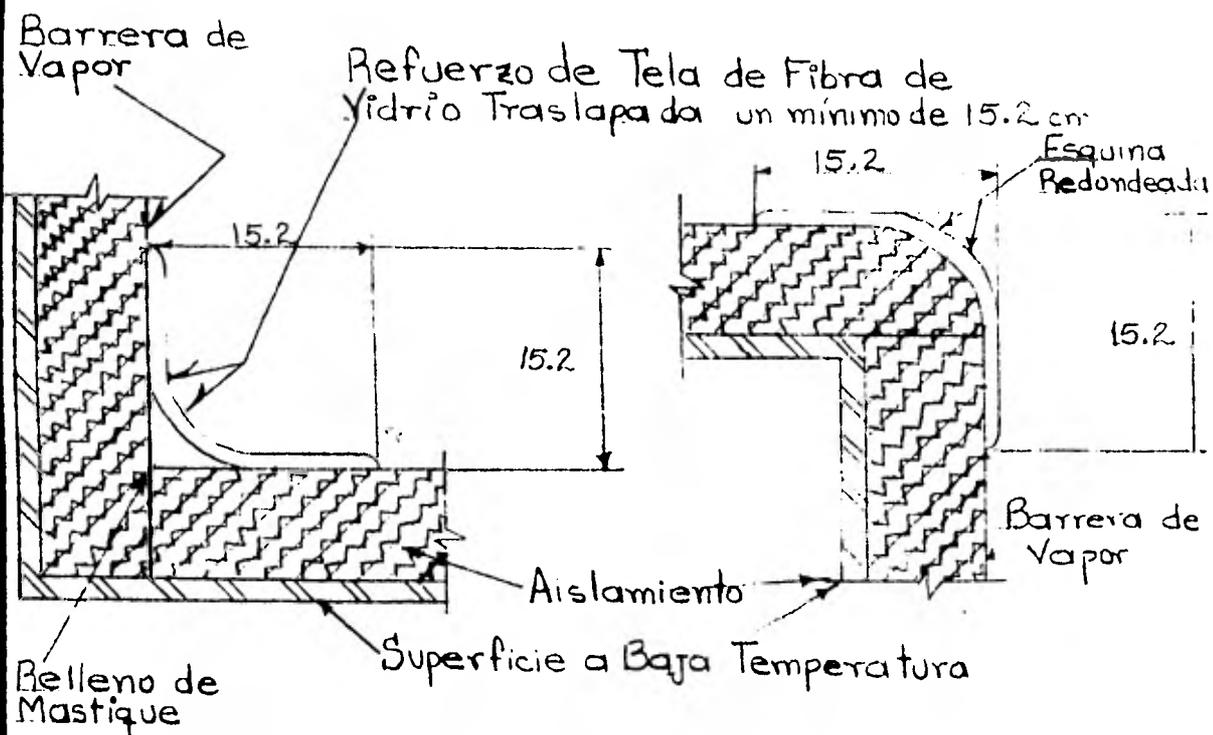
Aislamiento de Esquinas con Barrera de Vapor Reforzada.
